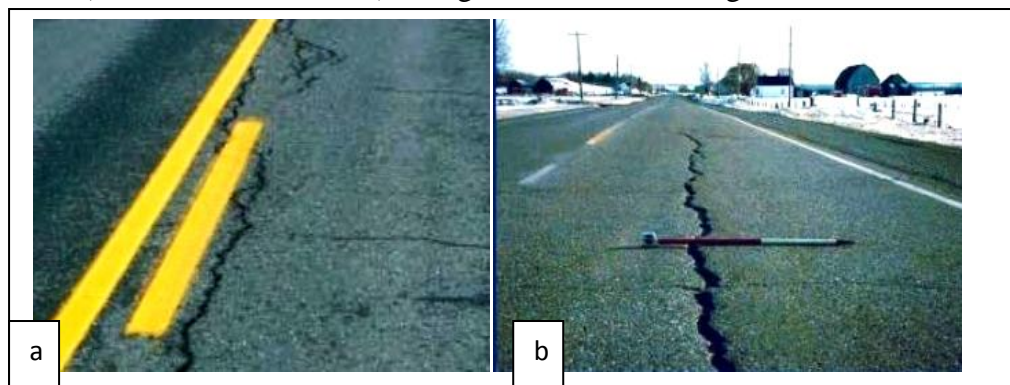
Fissures longitudinales (a : faible – b- majeur)
